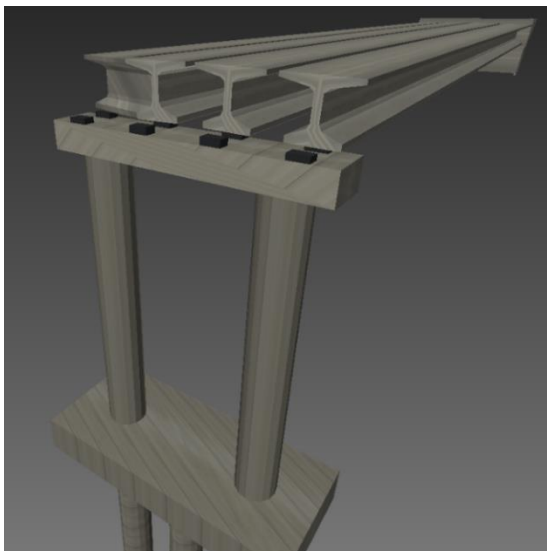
Detalles de las vigas, neoprenos y pila (Istram)
